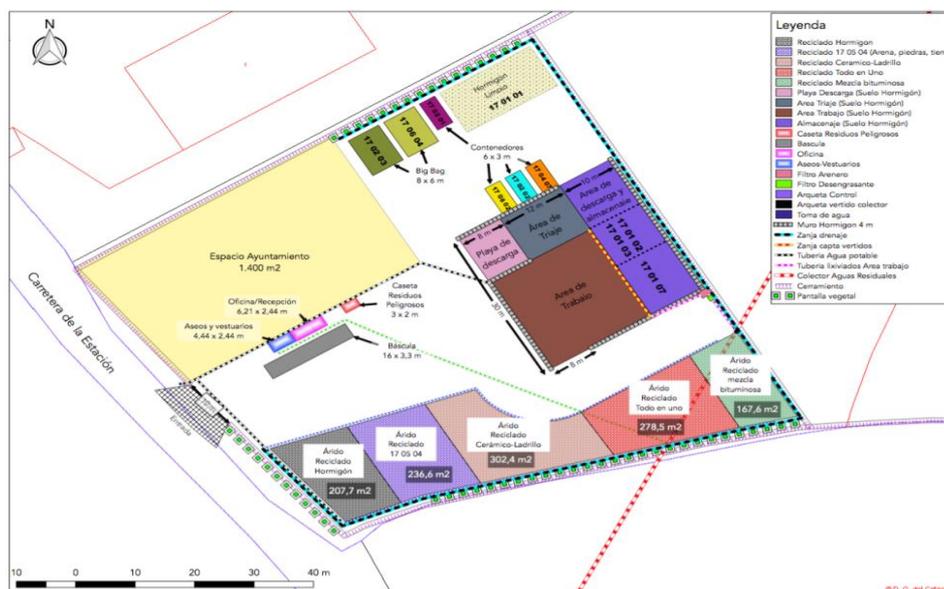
PLANO DE LA PLANTA PILOTO EN SAN VICENTE DE ALCÁNTARA. FUENTE [23].
